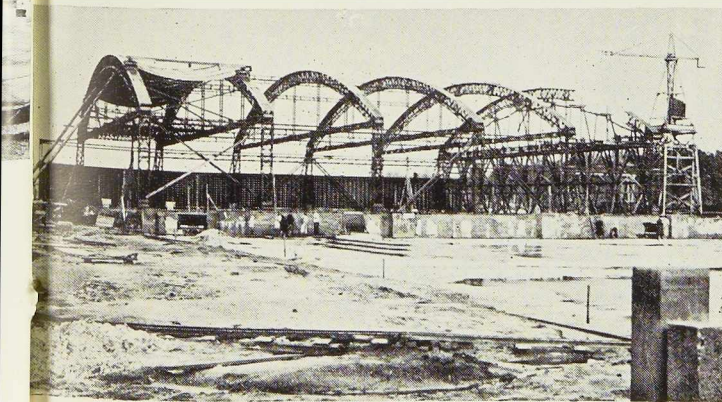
Tandis qu'on achève le montage d'un des arcs, on pose déjà, d'autre part, la toiture.
